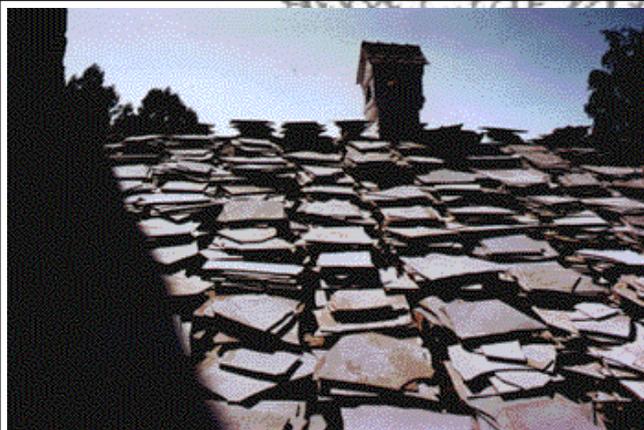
Vor dem Verlegen ausgestecktes Dach
